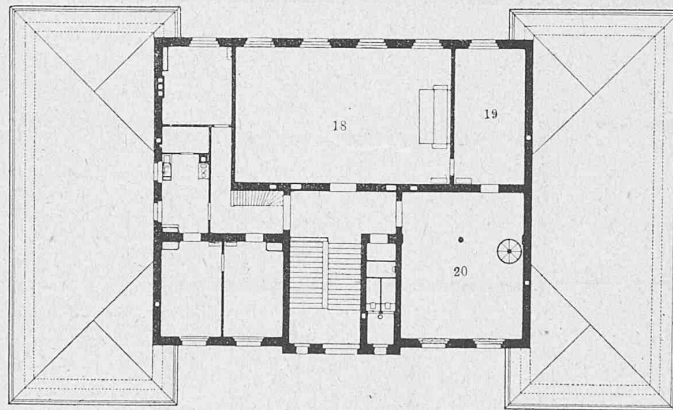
Grundriss vom ersten Stock. — Masstab 1 : 200.
